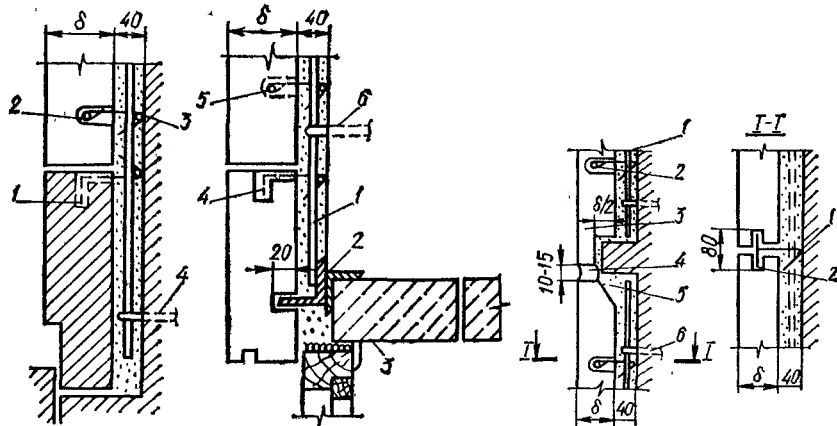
Узел крепления нижнего ряда плит из природного камня над цоколем:
